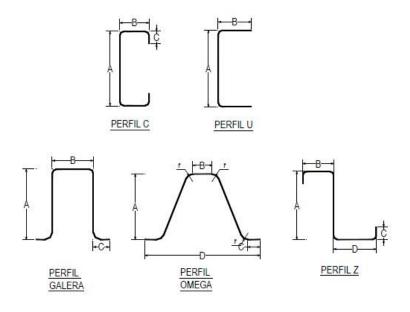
Secciones de perfiles - Sistemas *Steel Framing*. Fuente: (ConsulSteel, 2014).
